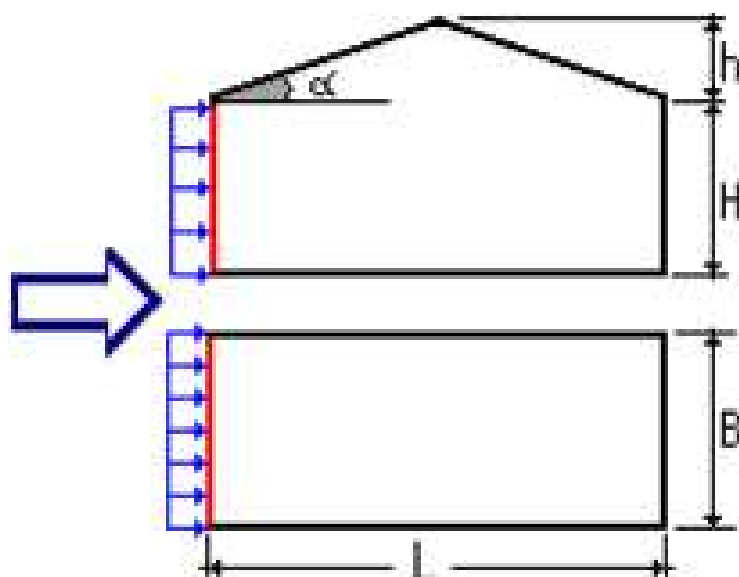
Схема приложения ветровой нагрузки на наветренную сторону
